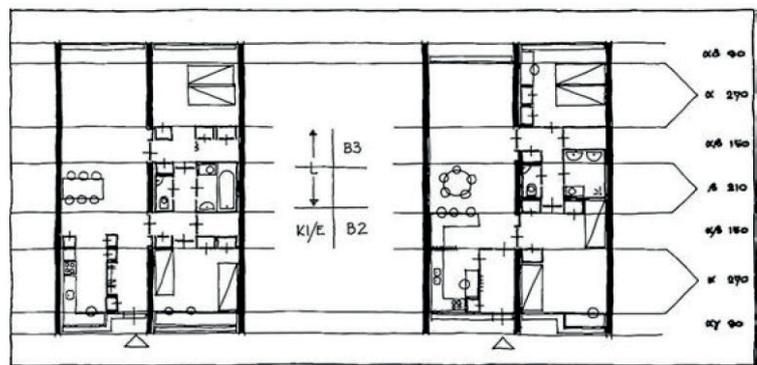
Plantas con sistemas modulares. Fuente: Montaner (2015)
